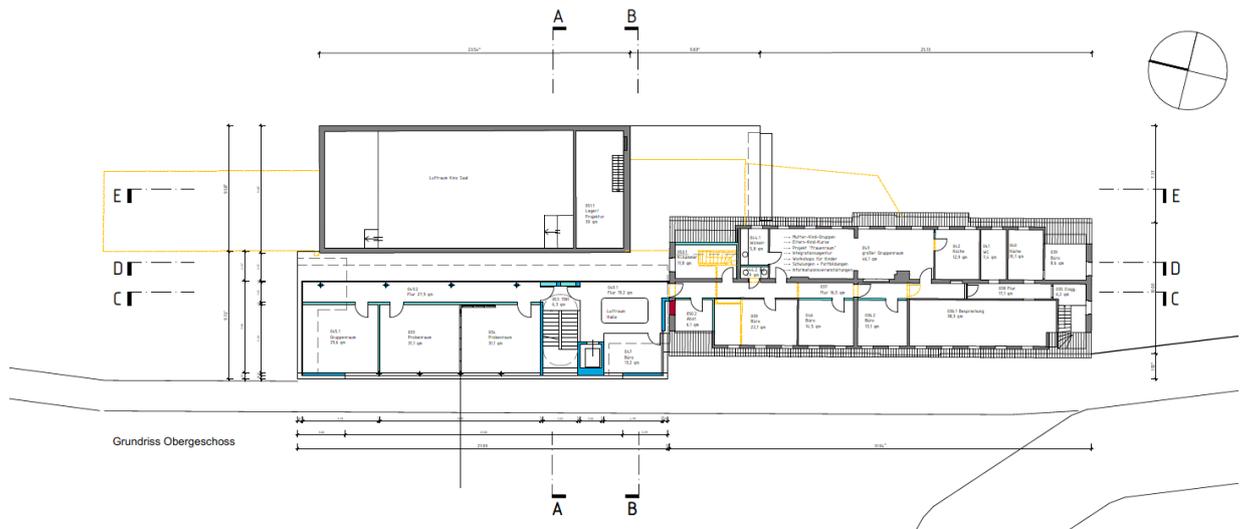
Grundriss Obergeschoss (Quelle: ARCHITEKTUR | ENERGIE, Dipl.-Ing. Ursula Jungius, Essen, April 2022)
